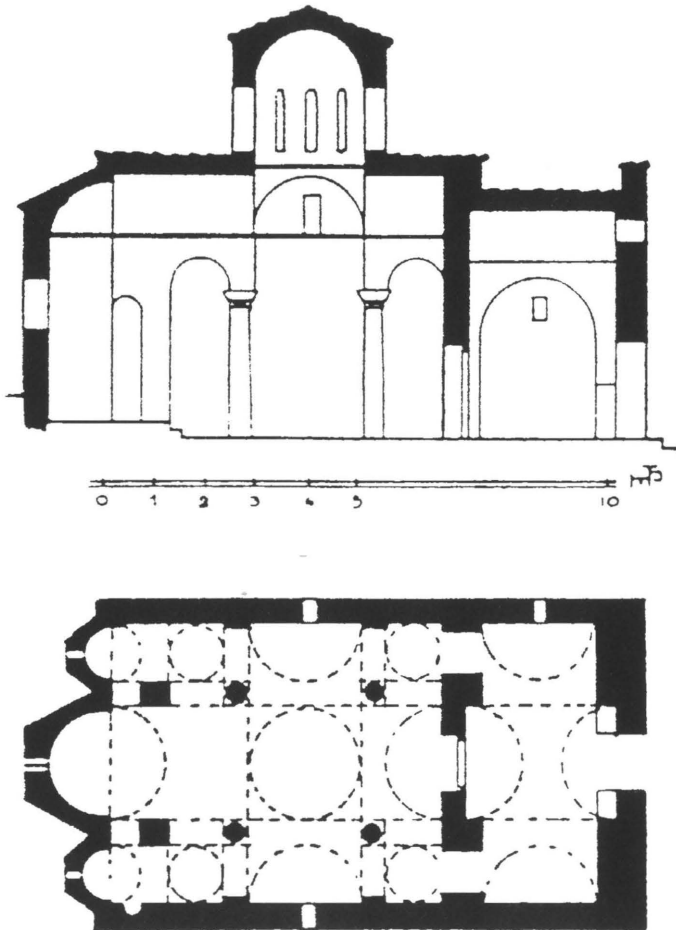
Schnitt und Grundriß einer Kreuzkuppelkirche
